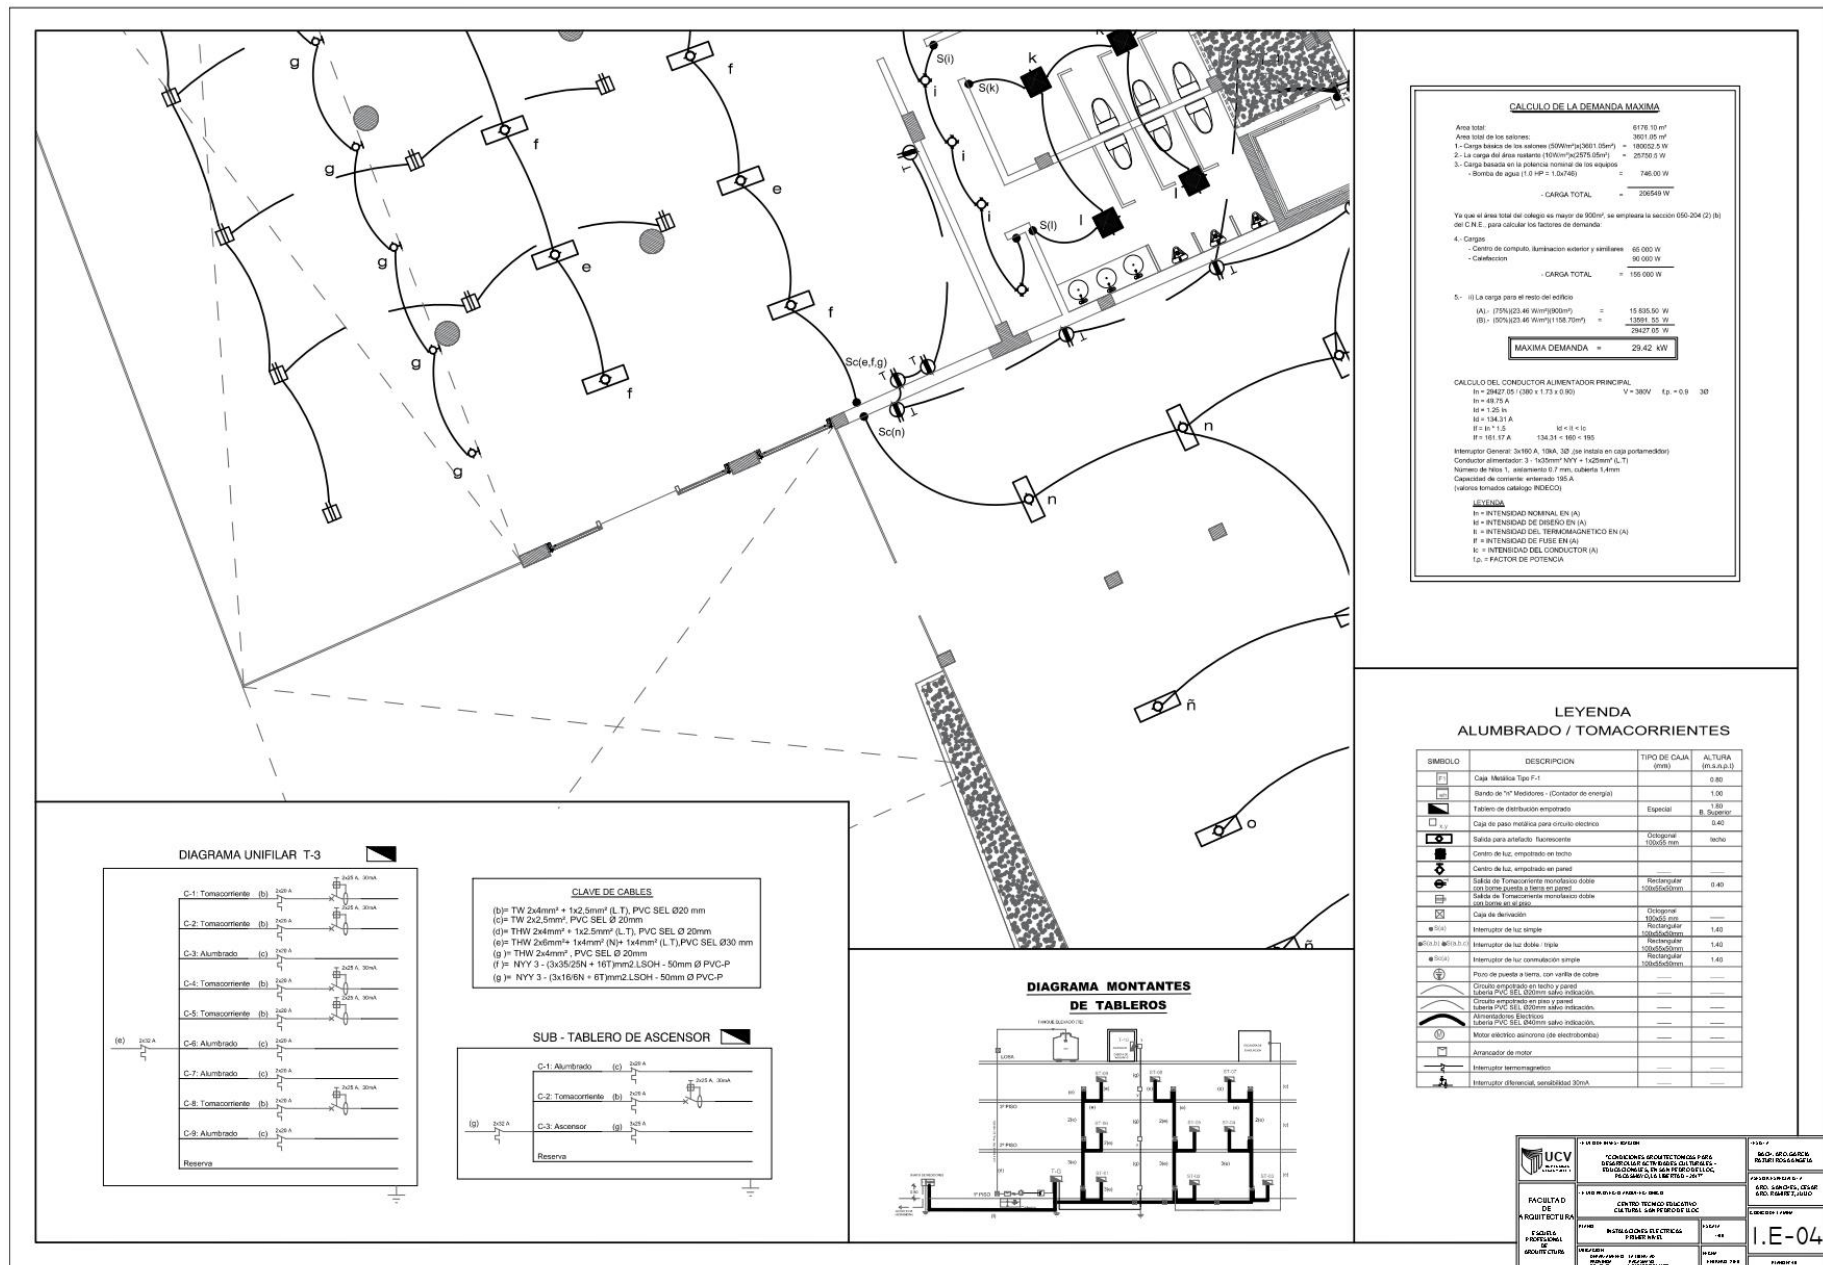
Plano de Instalaciones Eléctricas 1er Nivel - Plano N° 49 - Lámina N°: I.E. - 04
